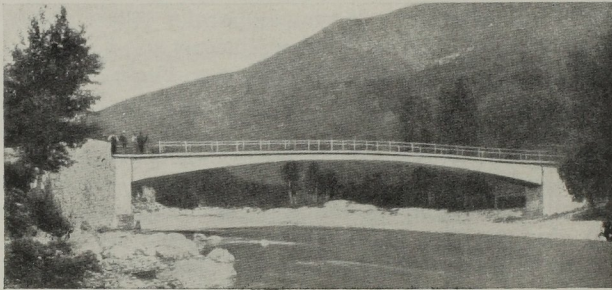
Pont de *Galvene*. Arc solide aux Sommiers et plancher; ouvert. m 34,50; flèche m 2,00
